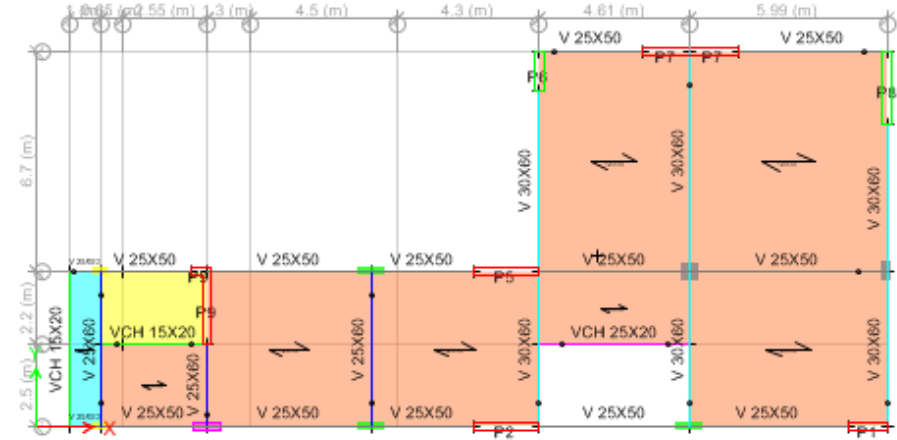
Vista en planta del modelamiento. Fuente propia
